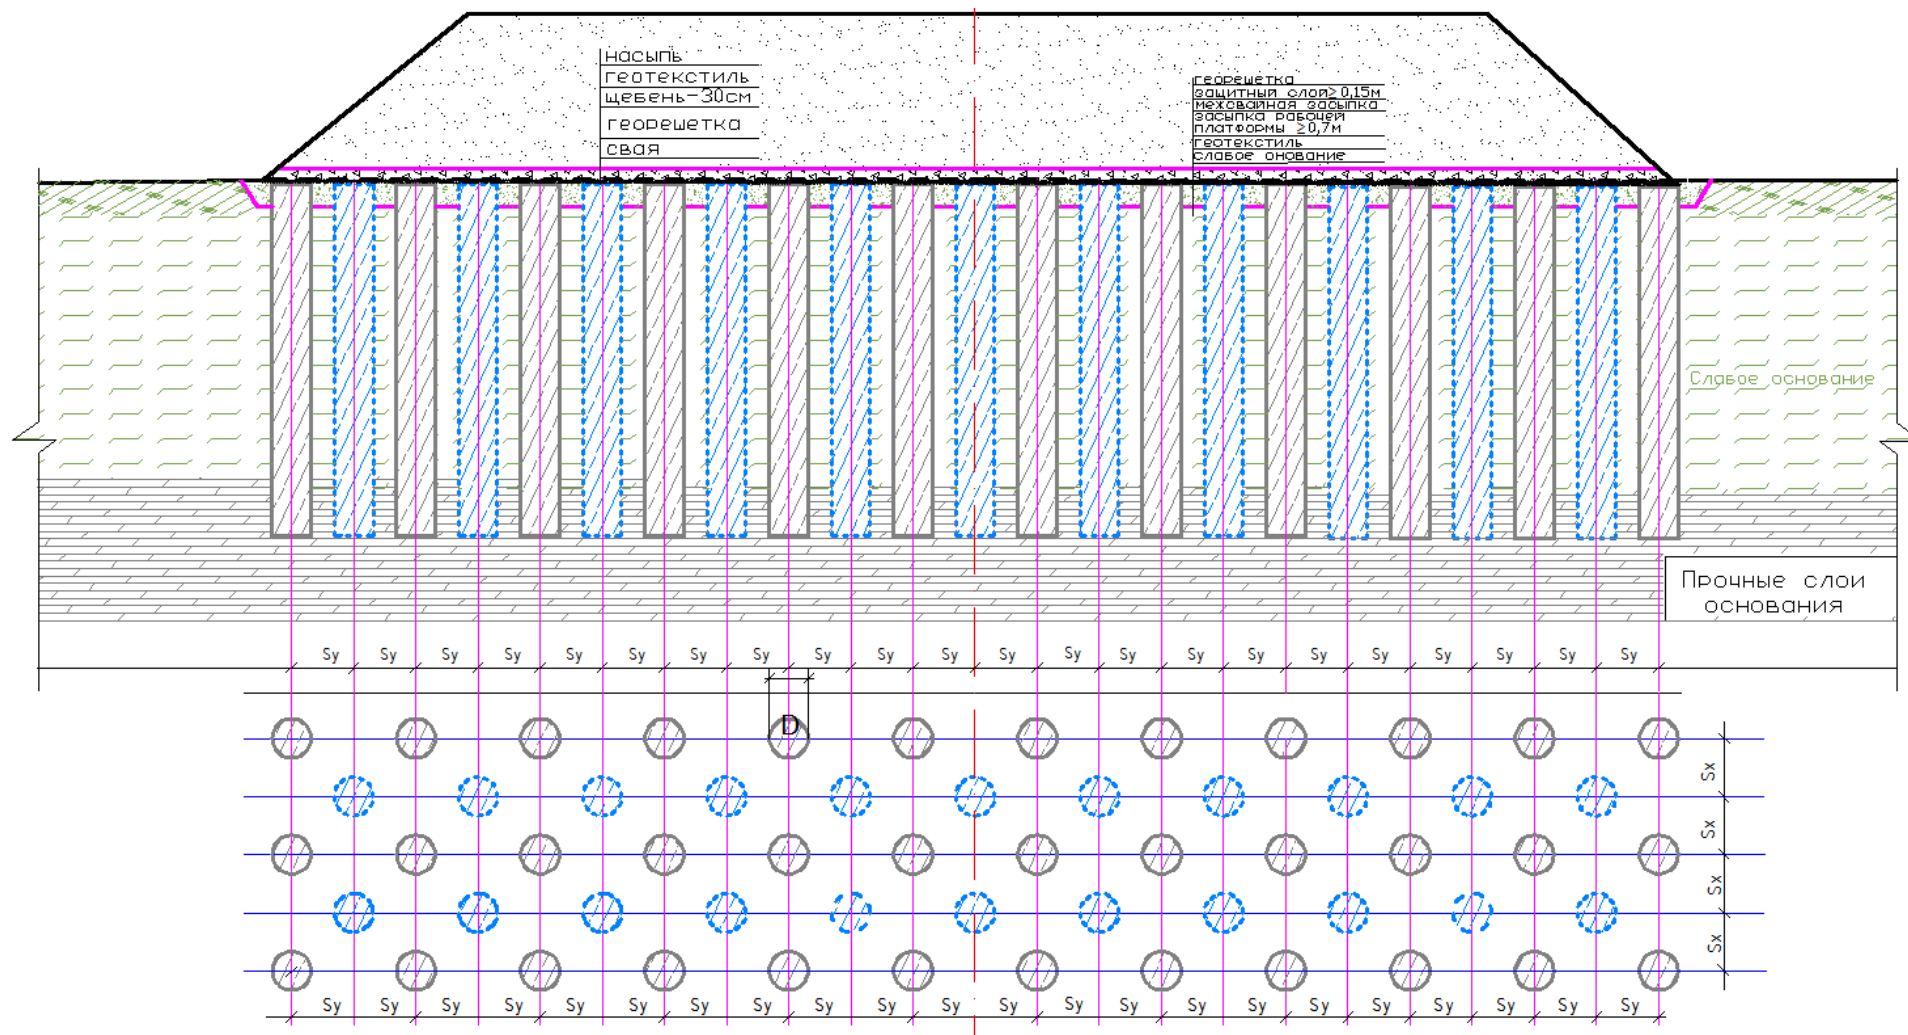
Гибкий ростверк из одного слоя георешетки со щебнем на круглых сваях
